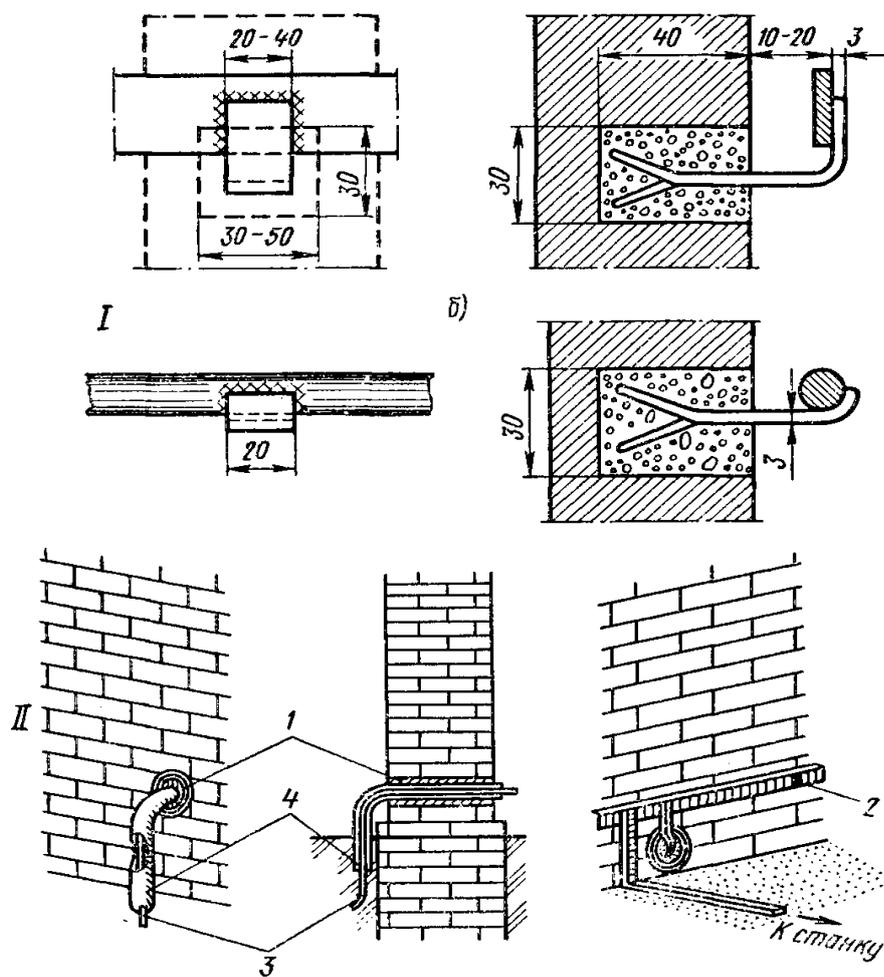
Прокладка заземляющих проводников: / - в сырых помещениях и на основаниях, не позволяющих крепление с помощью дюбелей; а - крепление проводников плоского сечения; б - то же, круглого сечения; II - способы прохода через стены и обхода проемов: 1 - цемент; 2 - дюбель; 3 - полоса заземления; 4 - труба
